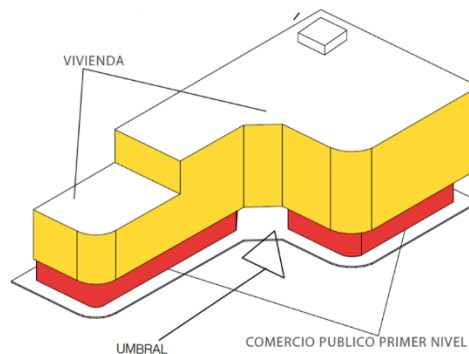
Axonometría de tipología edificación tipo de Vivienda.
